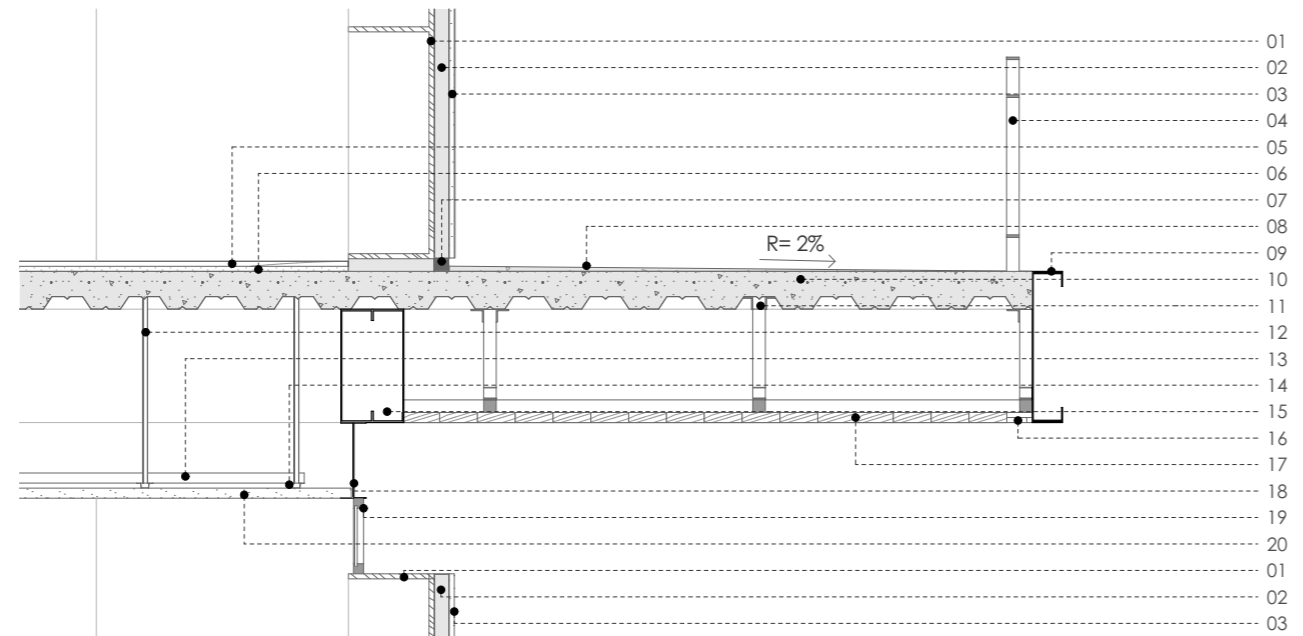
Esquema Sección B-B | Fuente: Elaboración propia
